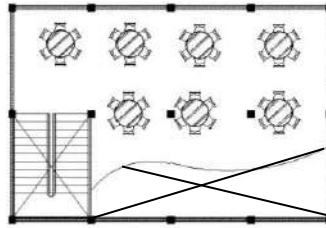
Layout lantai 1 Kafetaria Akhir
